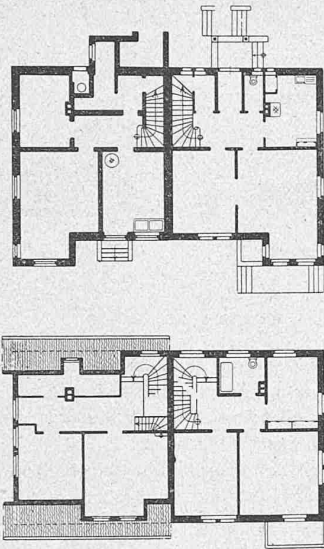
Grundrisse zu D. — 1:400.
